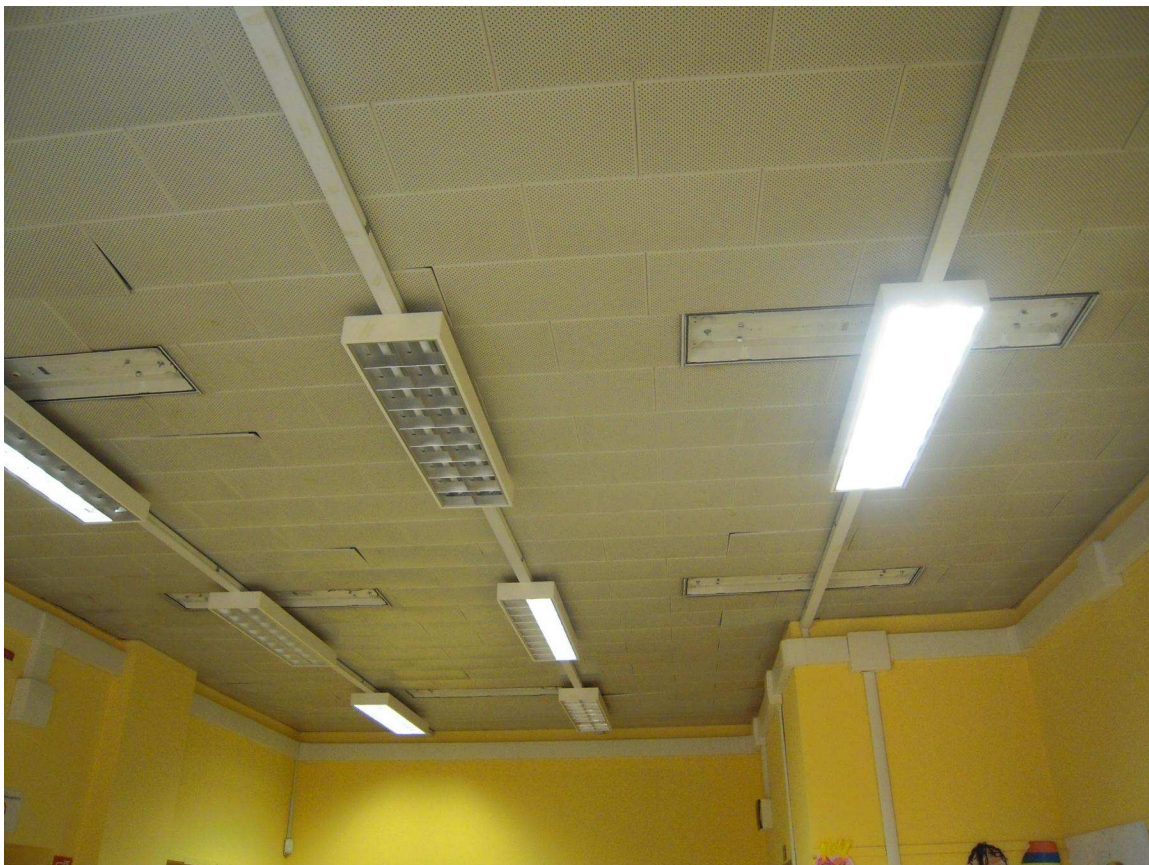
piano rialzato – porzione di controsoffitto in pannelli metallici forati
